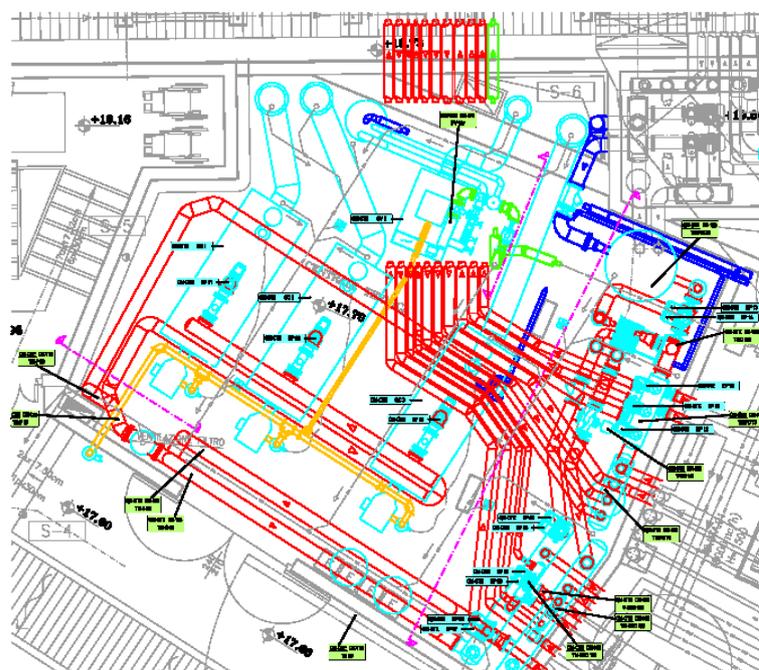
Particolare in pianta della centrale termica in copertura dell'ala nord.
